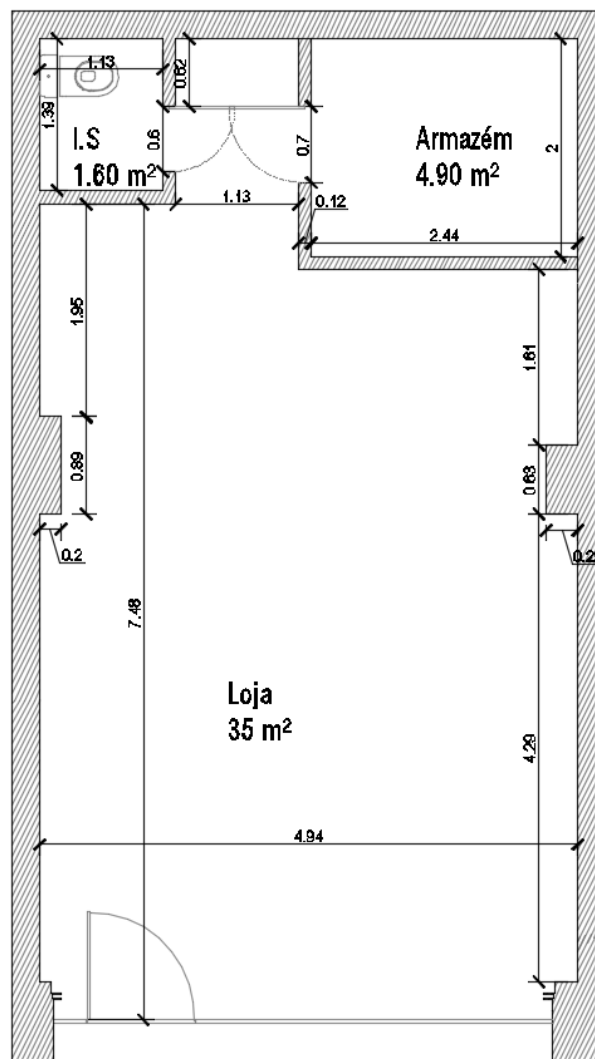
Planta original do espaço alvo de projeto. Fonte: autor
